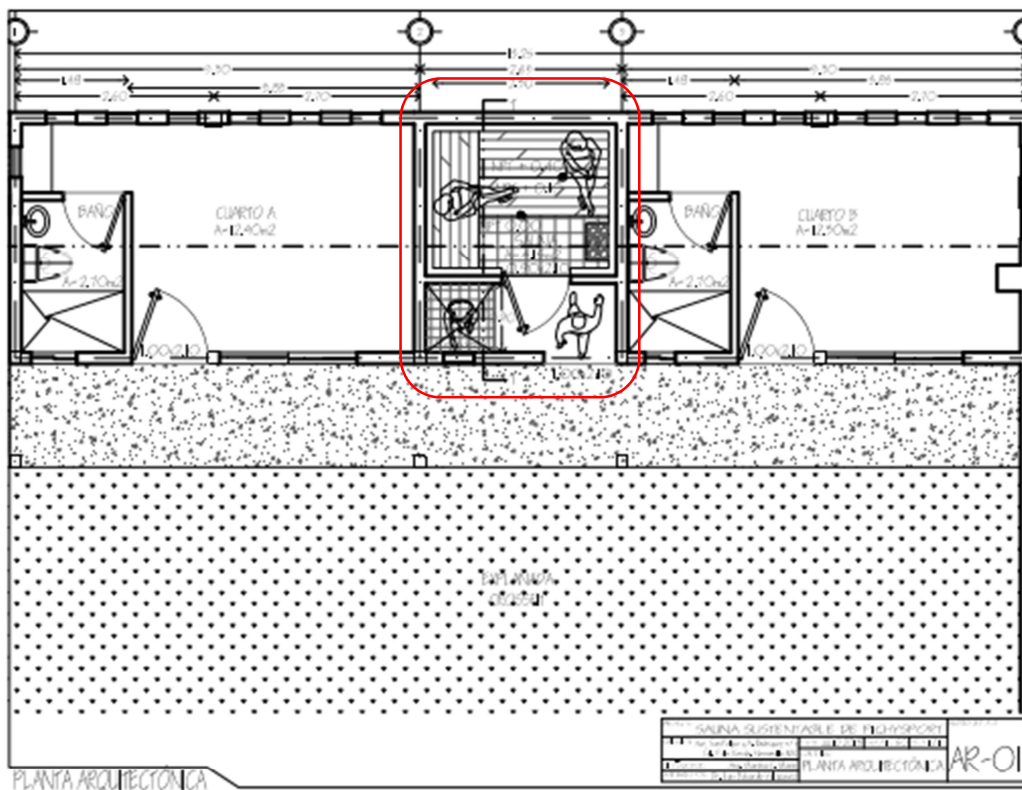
Planta arquitectónica del baño sauna (área en rojo)
